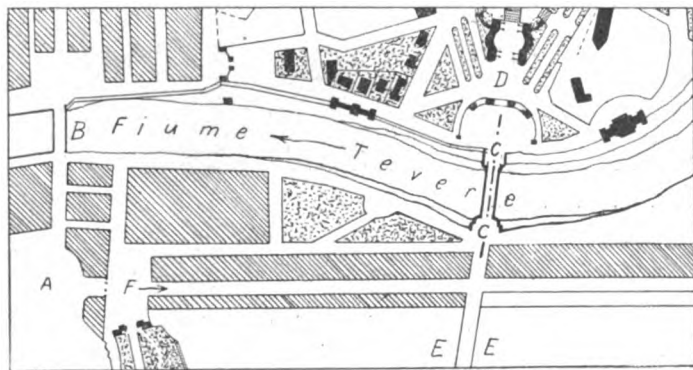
Planimetria generale e ubicazione del nuovo ponte.
